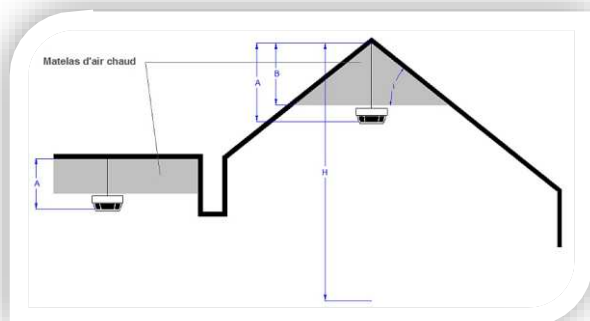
POSITION DU CAPTEUR PAR RAPPORT AU PLAFOND
